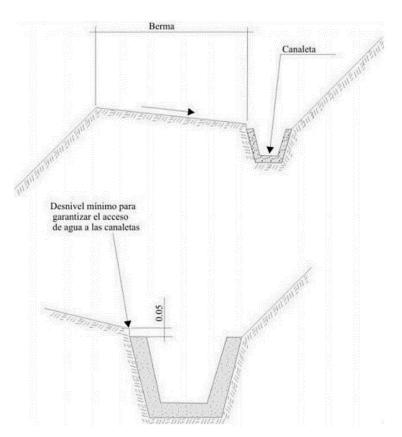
Detalle una canaleta de drenaje superficial (zanjas de coronación). Tomado de INGEMMET (2000).
